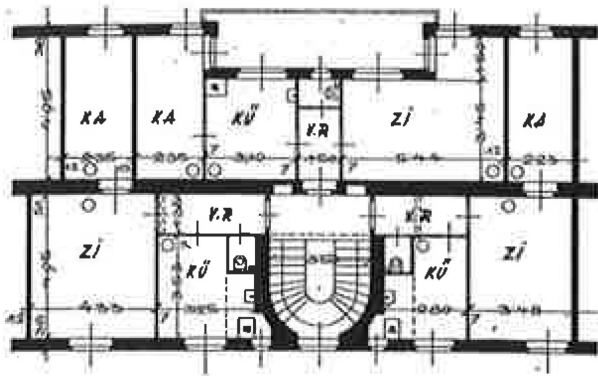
Grundriss Karl-Marx-Hof 1930
